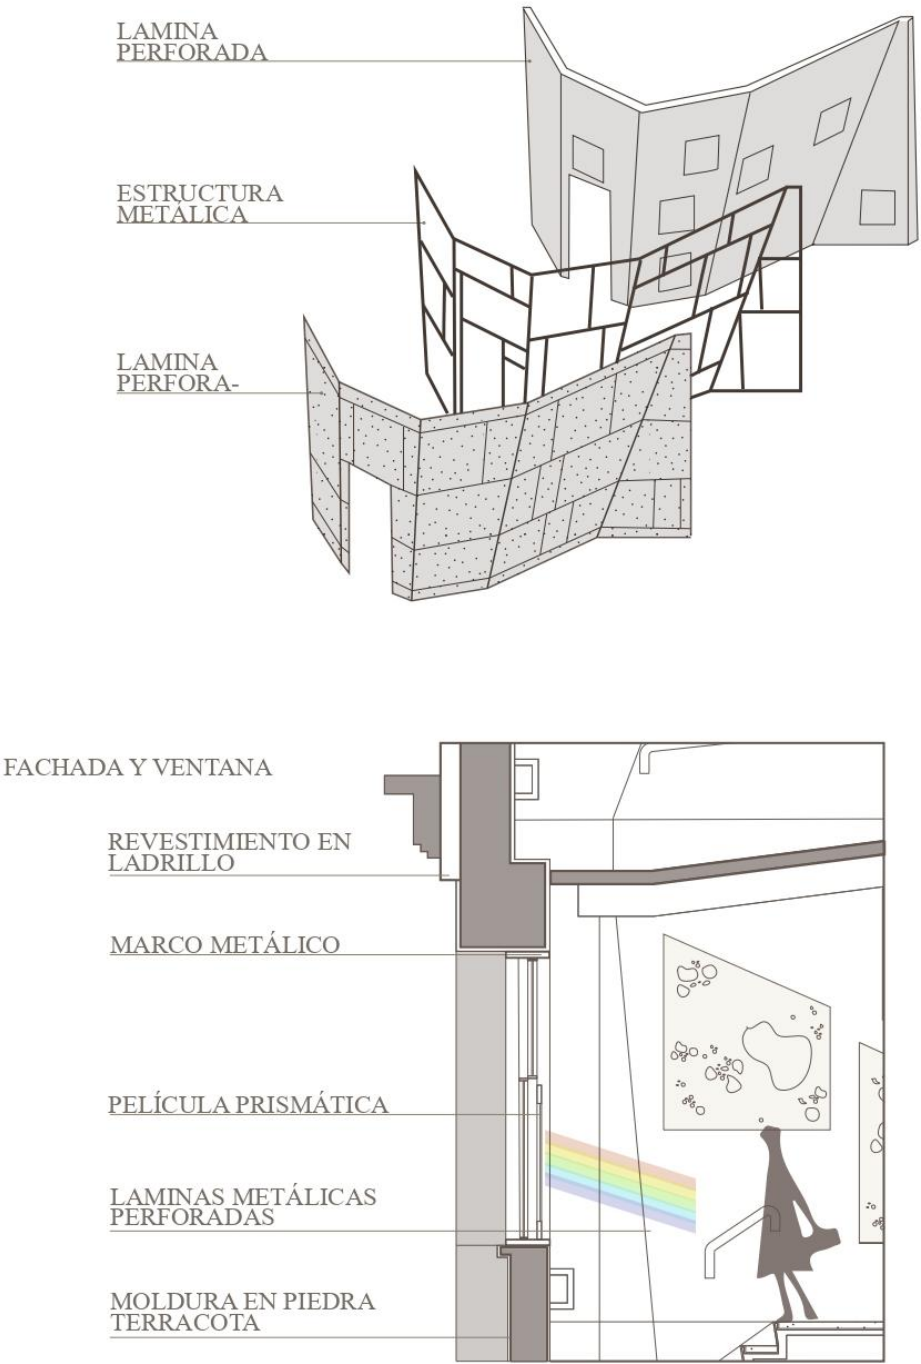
Detalles Constructivos Departamento de Filosofía de NYR (Autoría Propia 2025)
